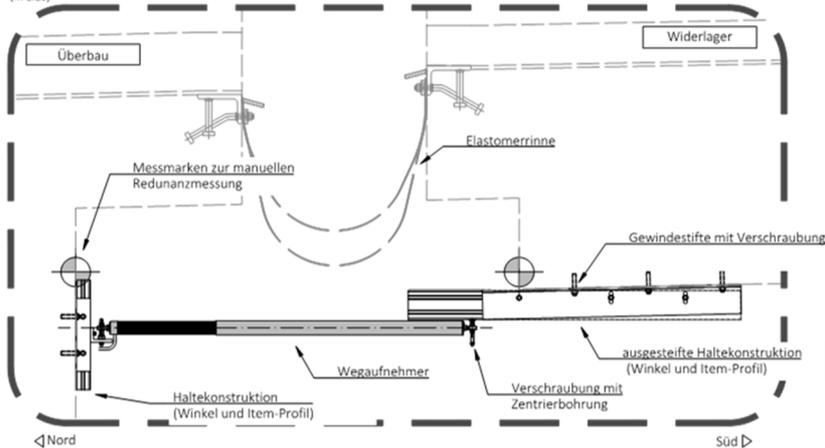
Beispiel für die Detailtiefe einer Ausführungsplanung hinsichtlich Sensorlage und -montage und Redundanzmessungen
